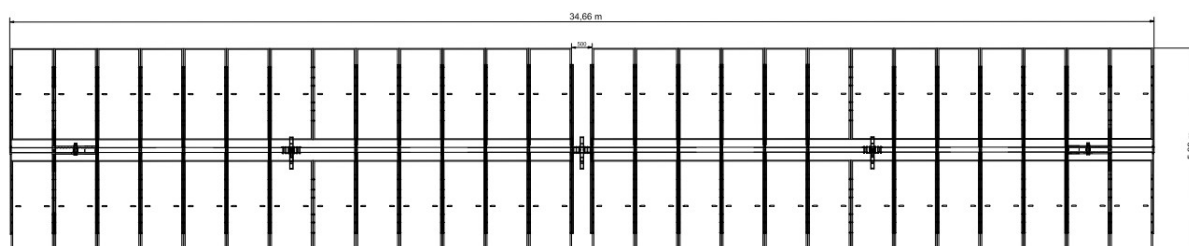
Pianta di filare di pannelli fotovoltaici in progetto
